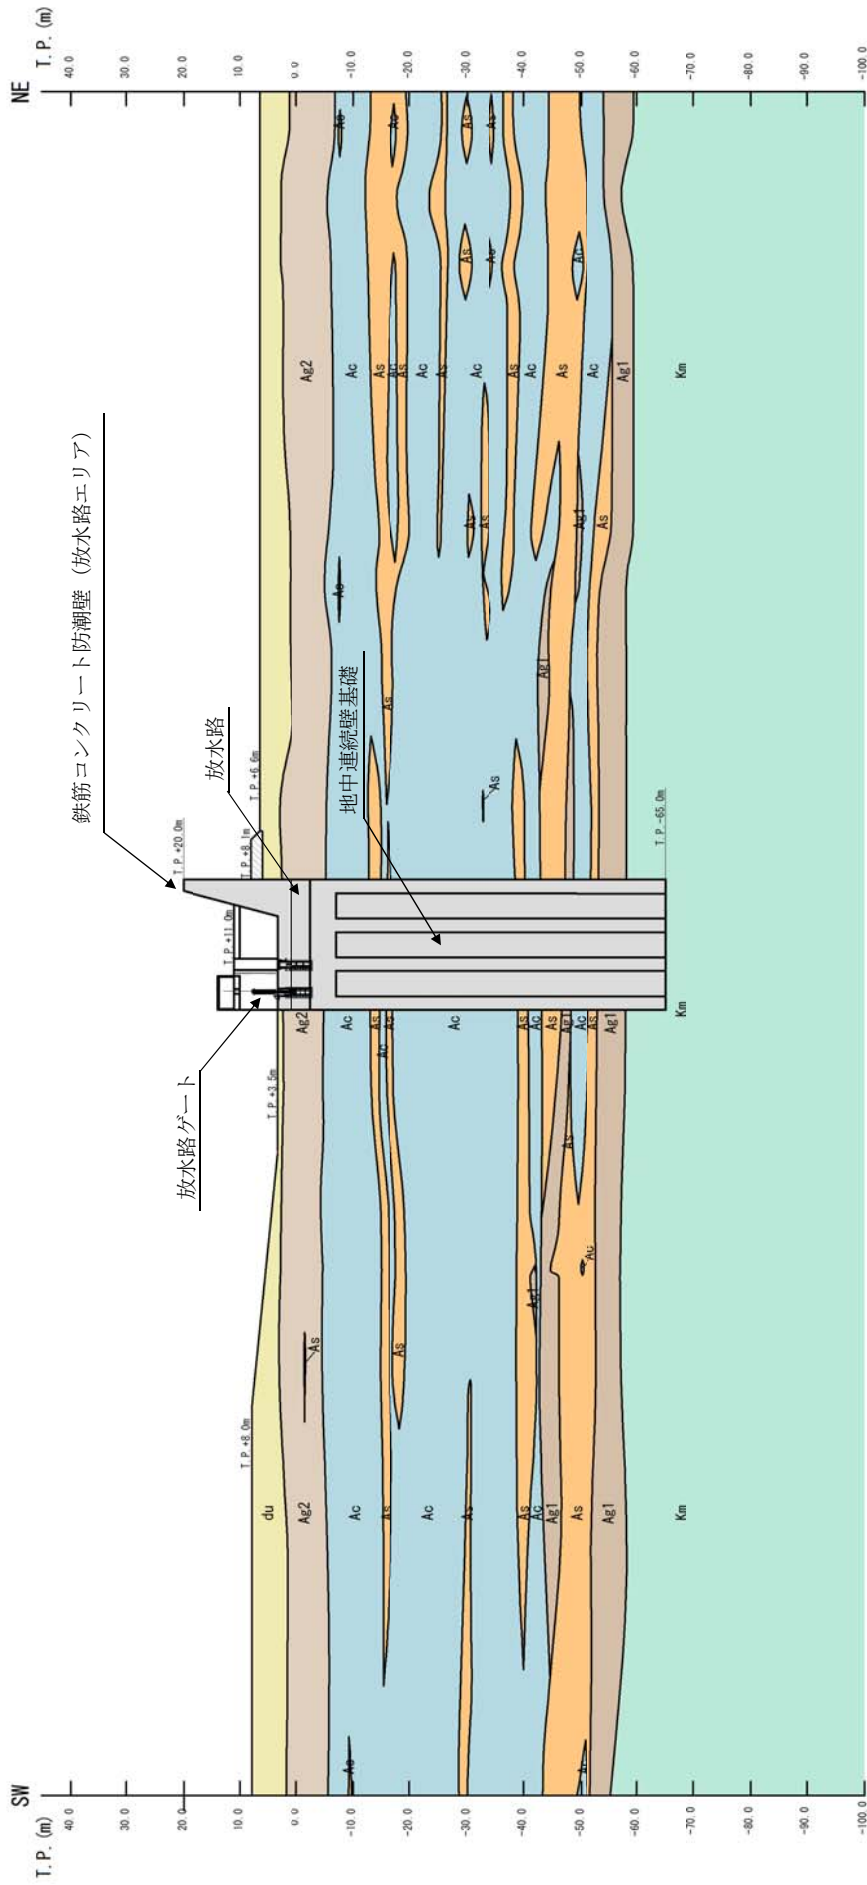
鉄筋コンクリート防潮壁 (放水路エリア) の評価対象断面図
